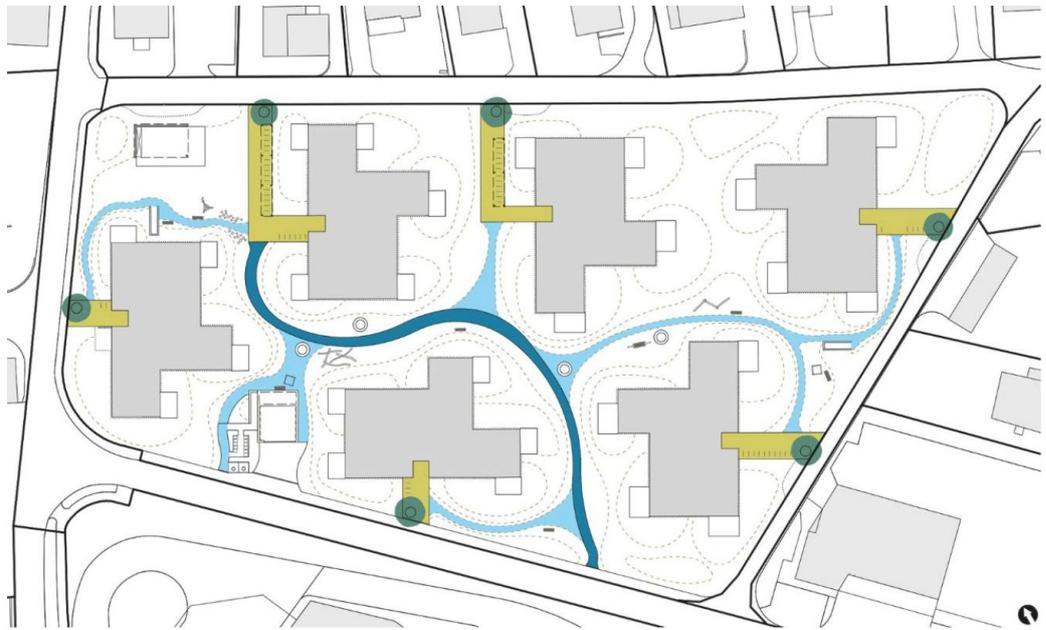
Hauszugänge bzw. Zugangsbereiche (Quelle: arcoplan klg, Ennetbaden)
